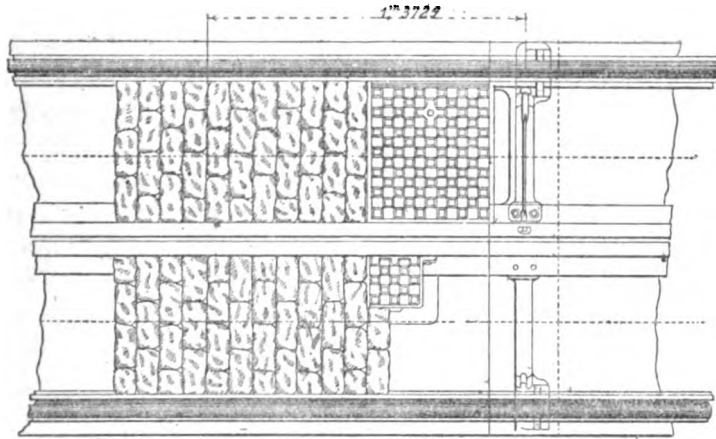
Canalisations souterraines du Metropolitan Railway de Washington, plan.
